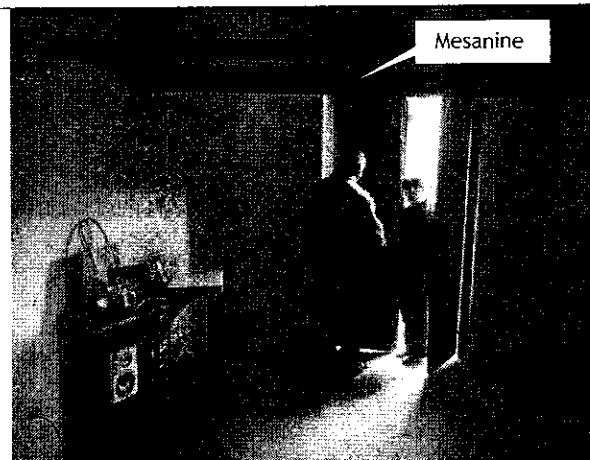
Vista de la cara interna del muro del costado norte del predio, donde no se observan lesiones estructurales ni en el muro, ni en la fracción del mezanine que se apoya en el sector.
